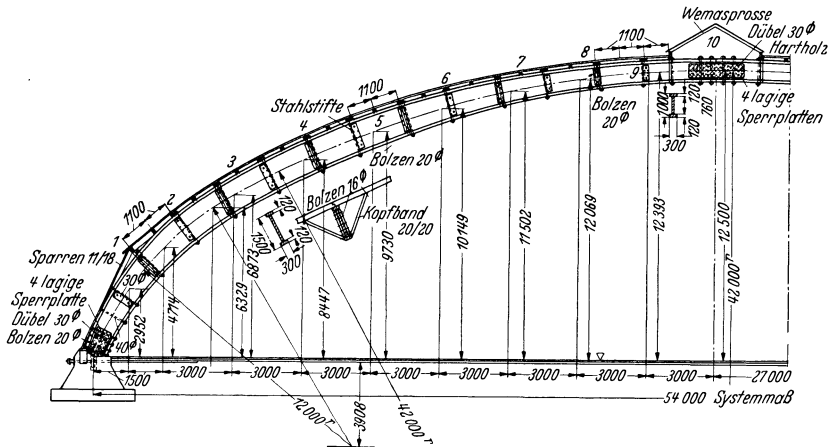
Salzlagerspeicher Doesburg (Holland) Binderkonstruktion.
